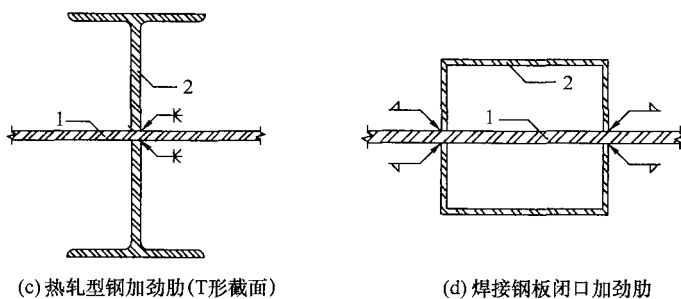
焊接加劲肋示意 (二)
